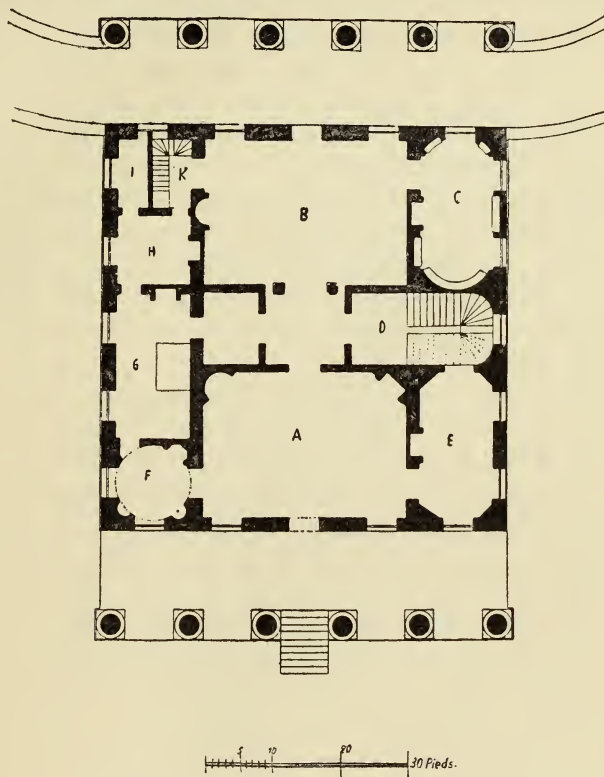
Grundriss des Baues bei Mainz, nach Stieglitz. (Zu S. 62.)
